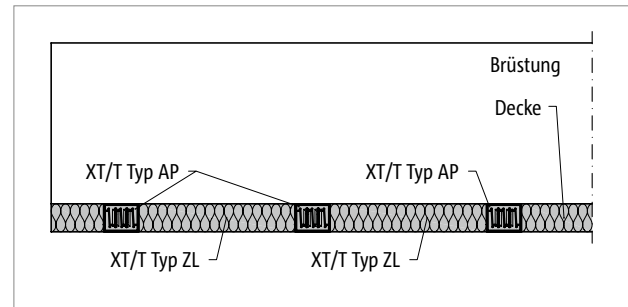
Schöck Isokorb® XT/T Typ AP horizontale Anordnung: Grundriss Brüstung vorgesetzt
